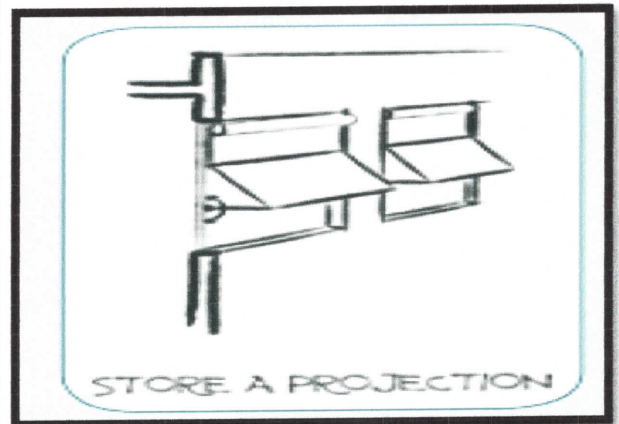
Stores à projection en toile, source: (Groupe de travail de l'ICEB 2014)
